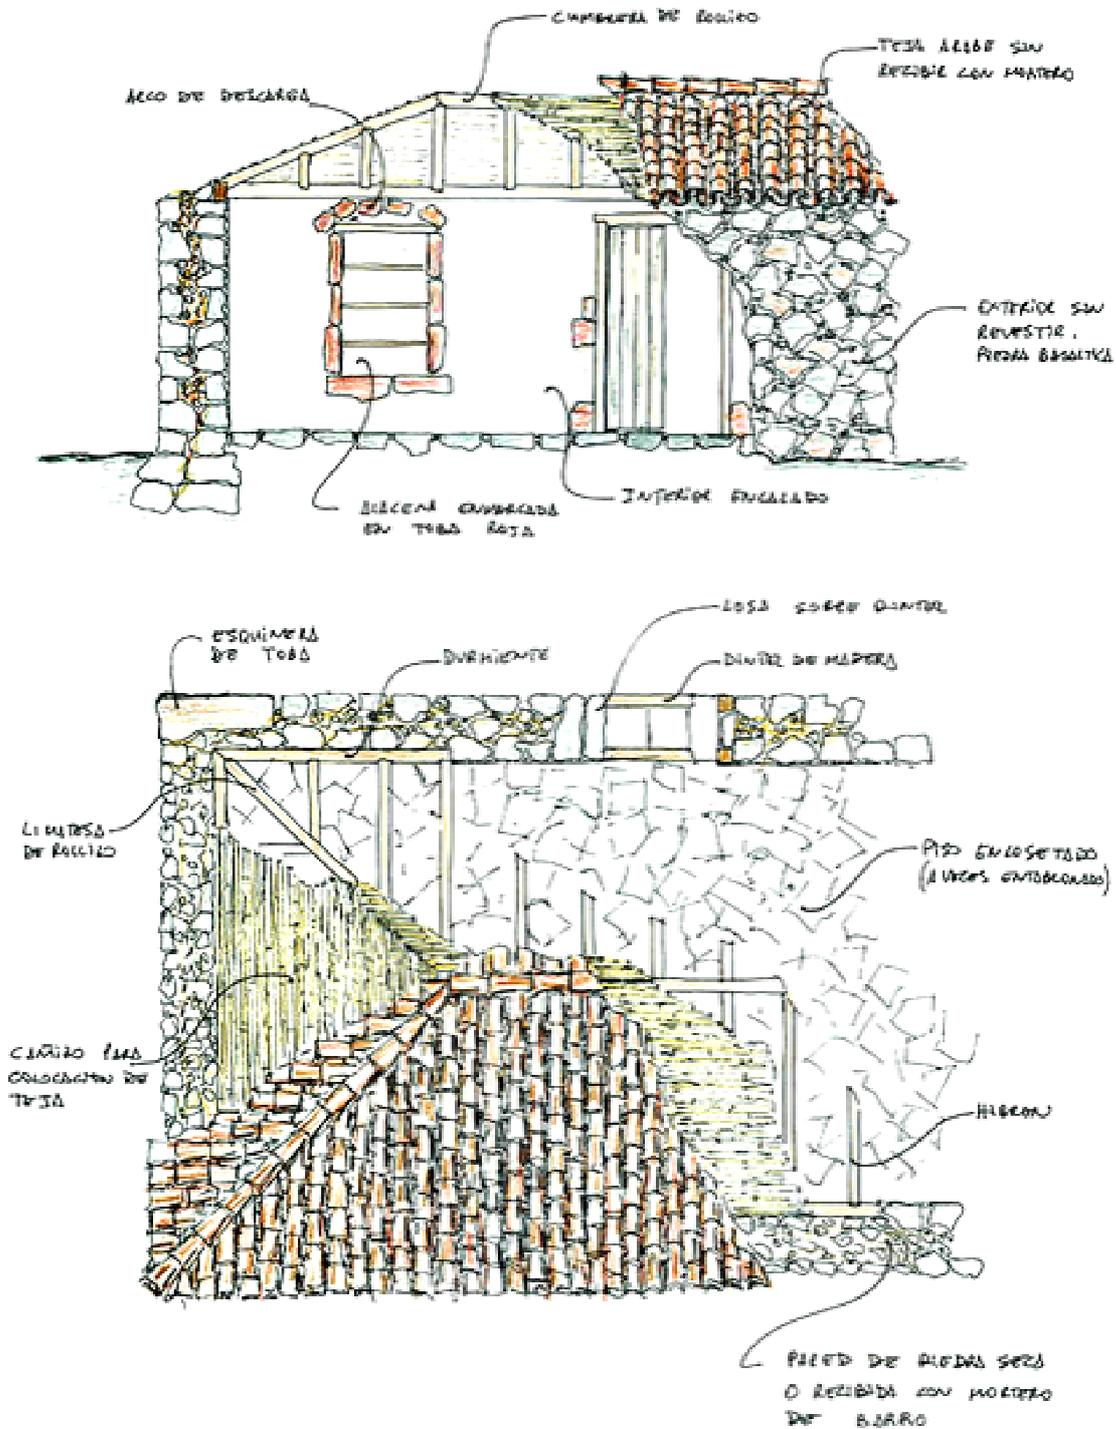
Aspectos constructivos más característicos en una edificación tradicional básica, donde se ponen de relieve los elementos que más se repiten en este tipo de construcciones. (Herrera García 2008)
